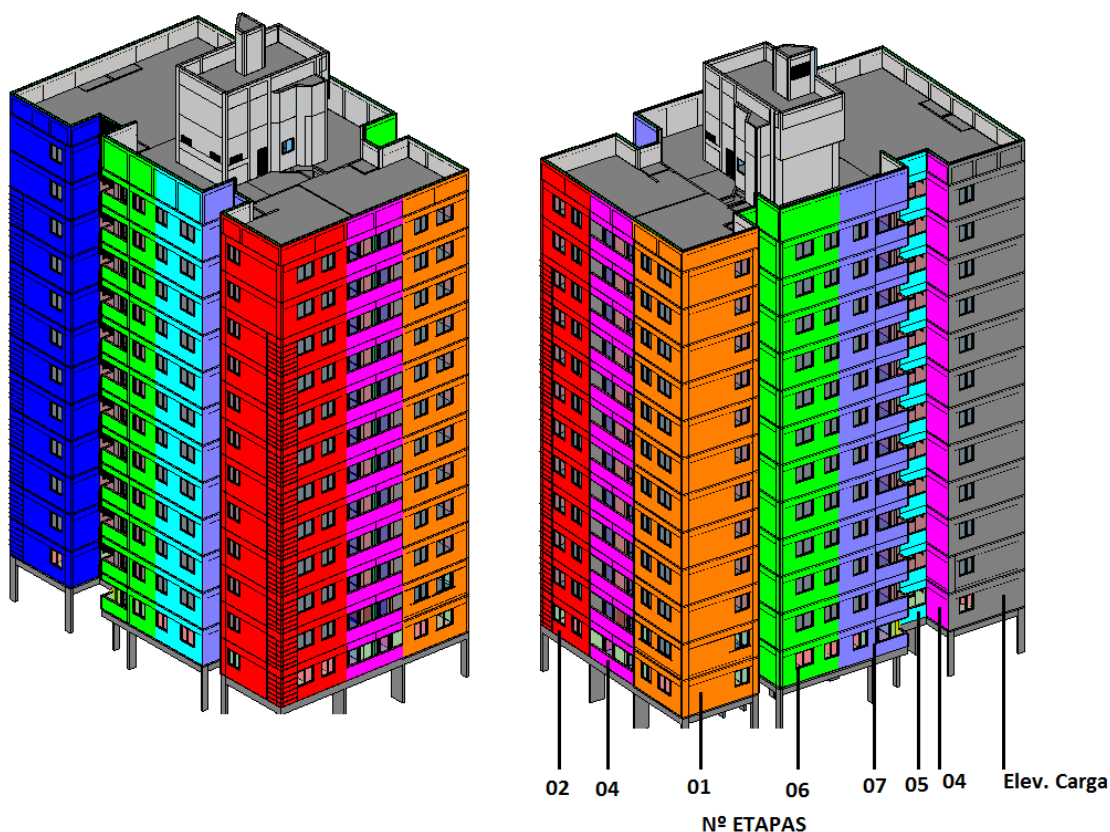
Planejamento da execução do emboço da fachada em etapas conforme panos de execução.
